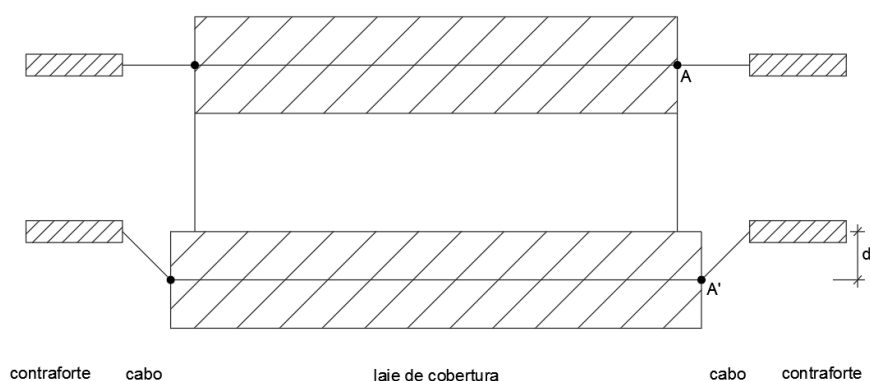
Esquema em planta da resposta da cobertura sujeita a um deslocamento transversal.
